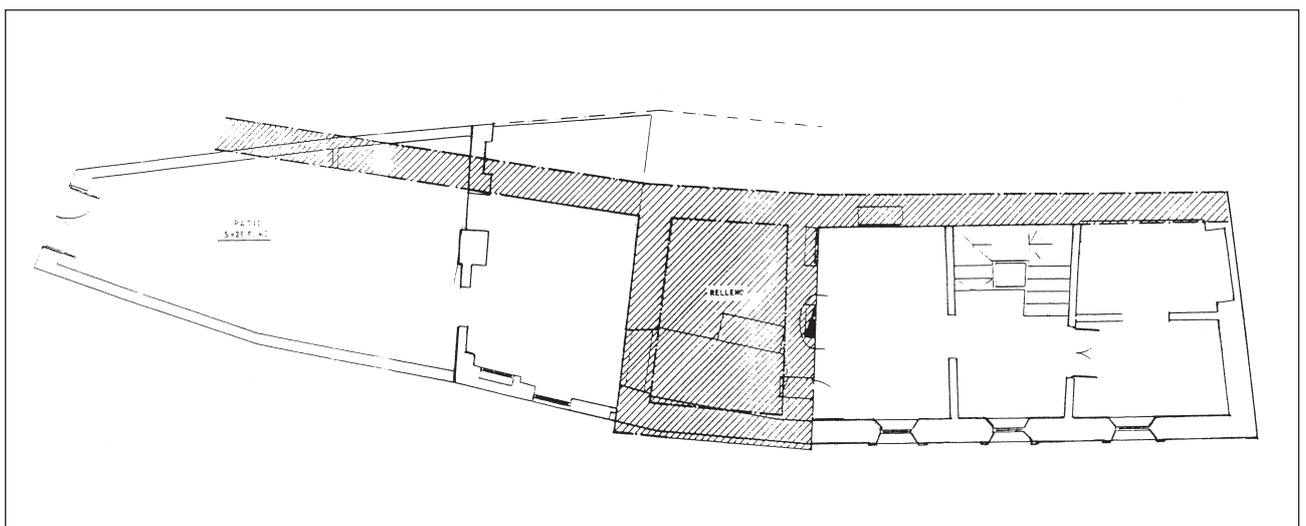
Trazado de muralla y torre n° 1. Planta primera. Estado actual.
